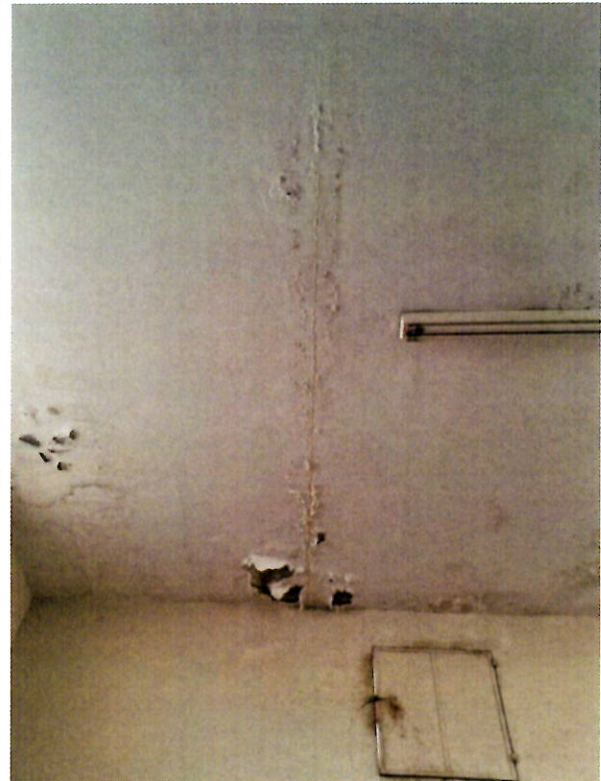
Infiltração sobre a laje do sanitário no salão principal
